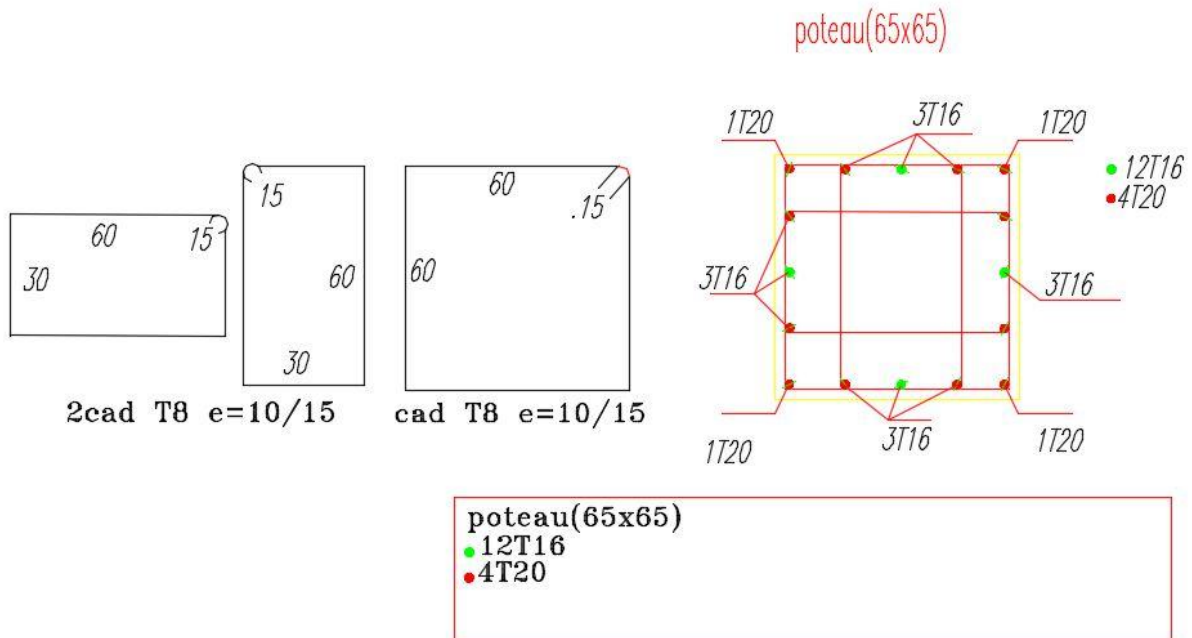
Coupe de ferrailage des poteaux 65×65 cm²
